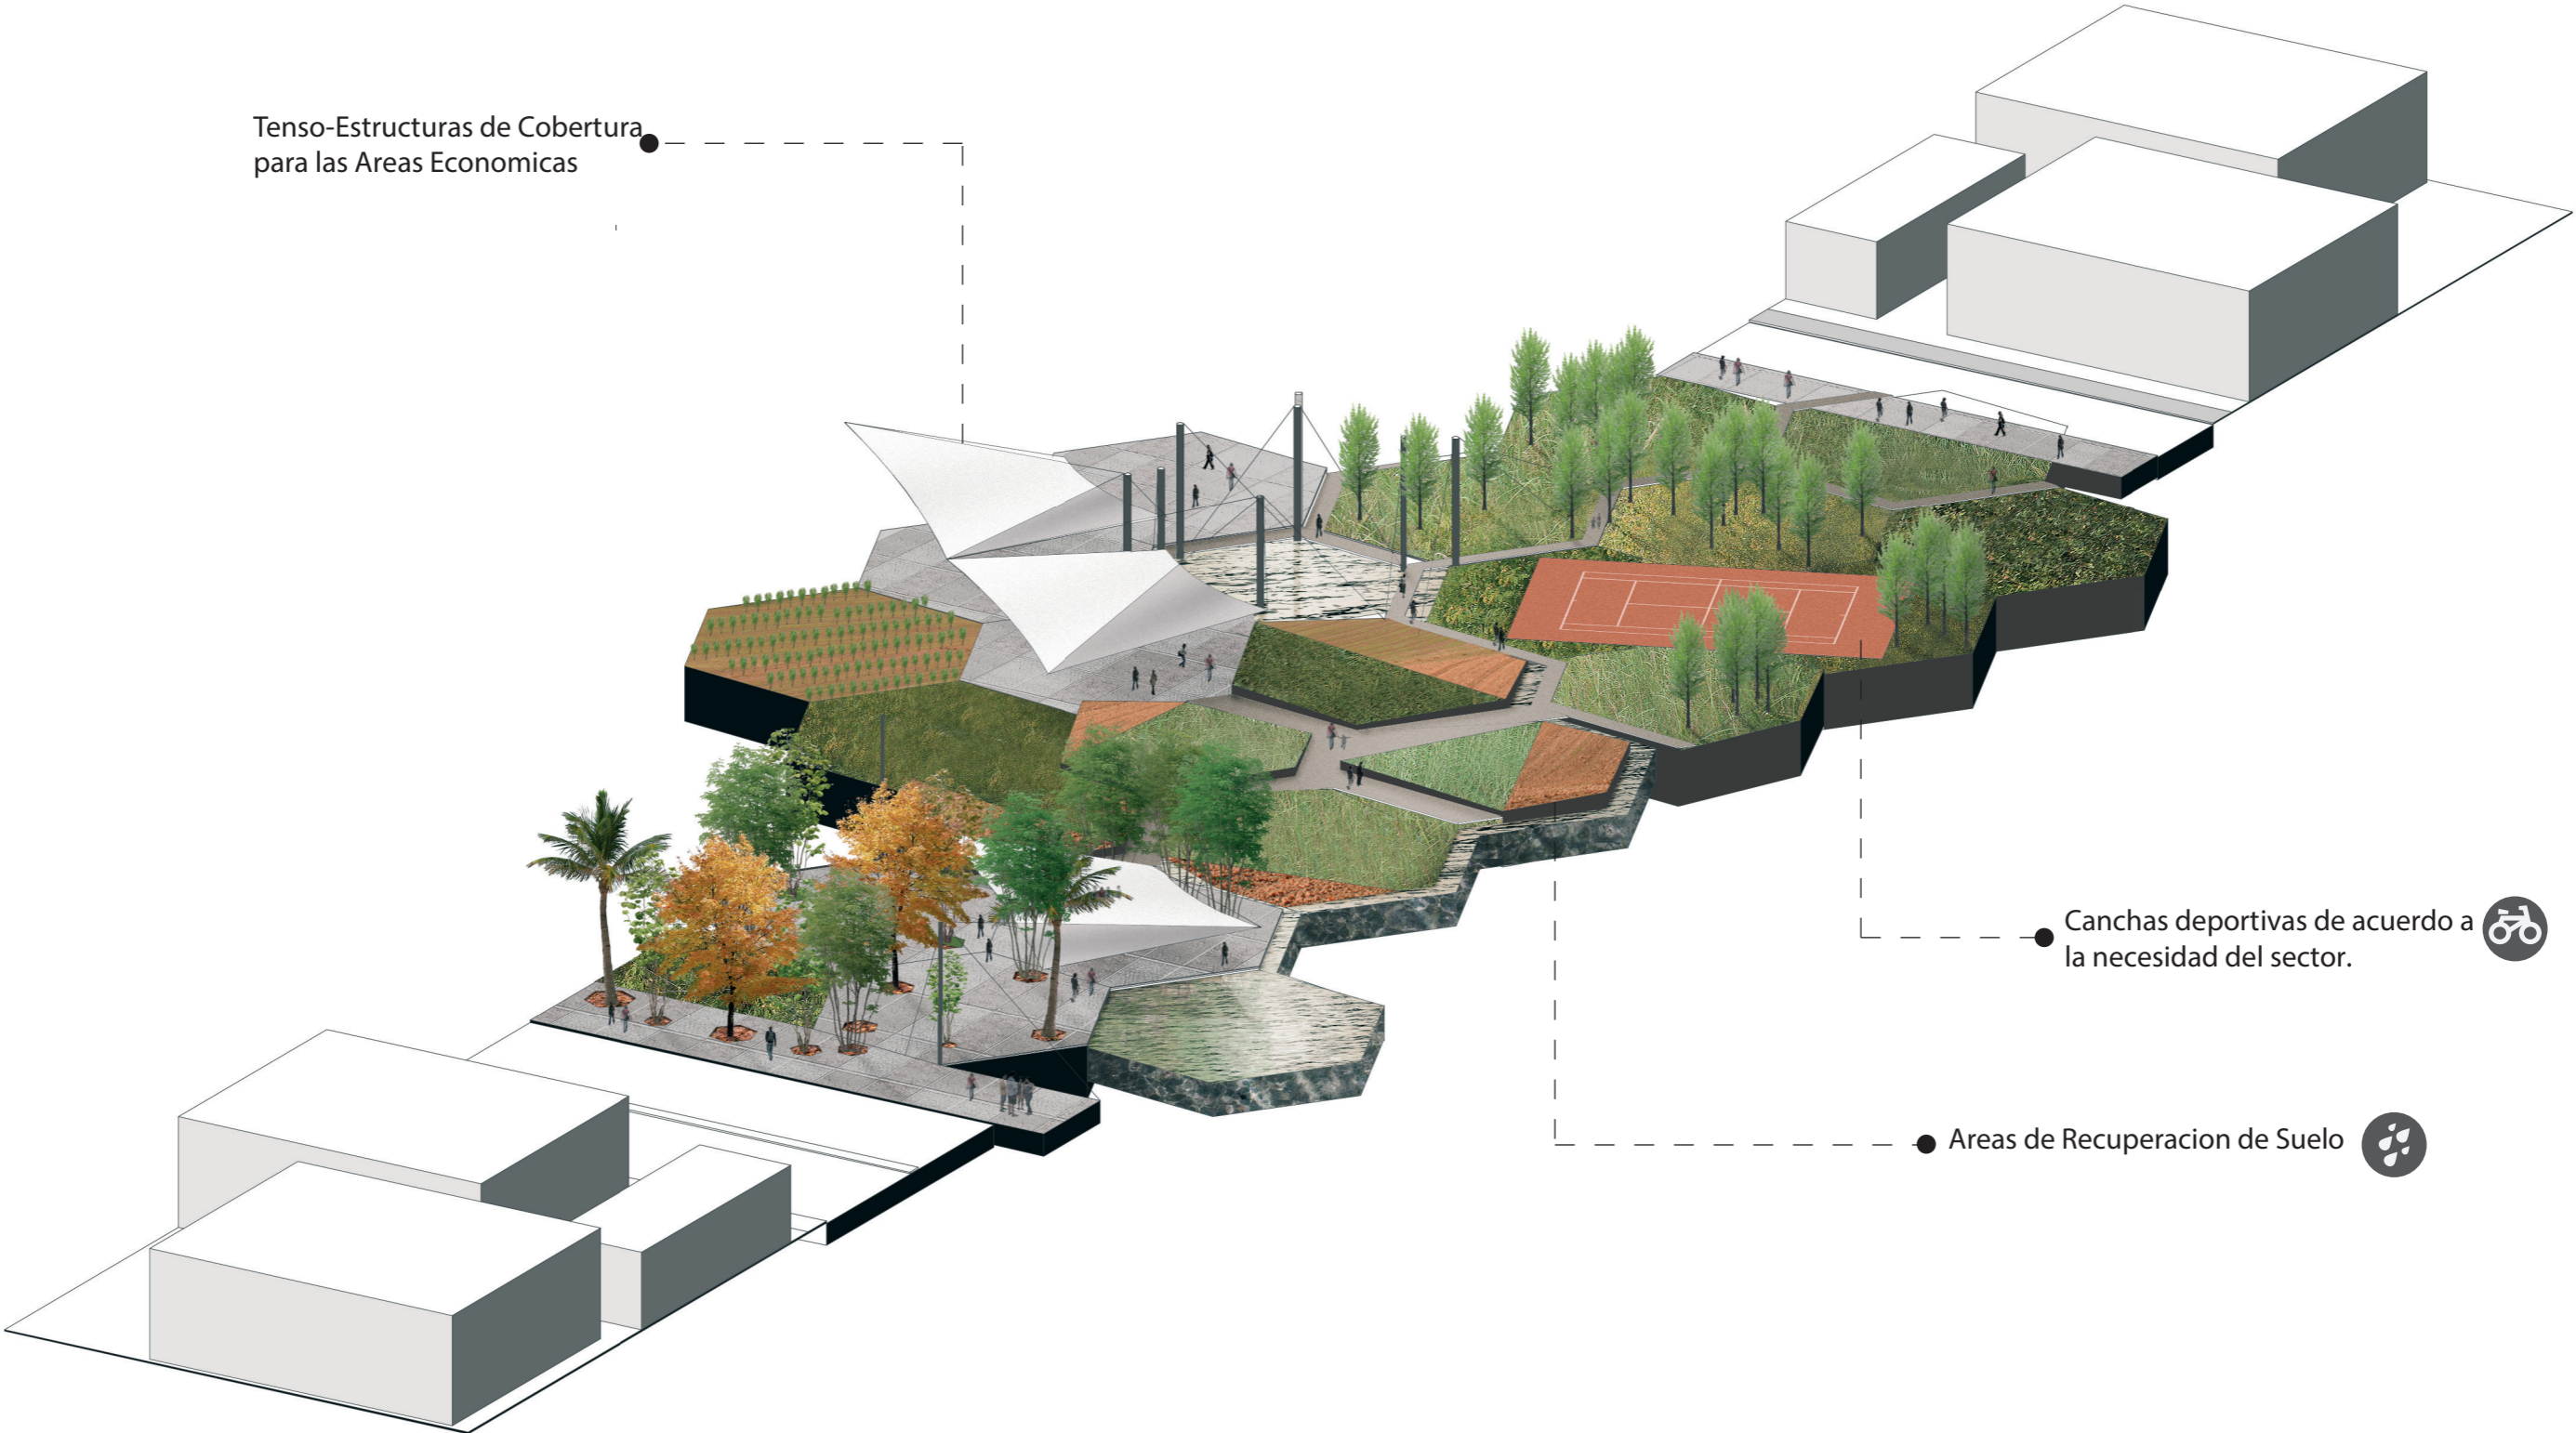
Plan Urbano de Intervención: Vista de Intervención en sección
